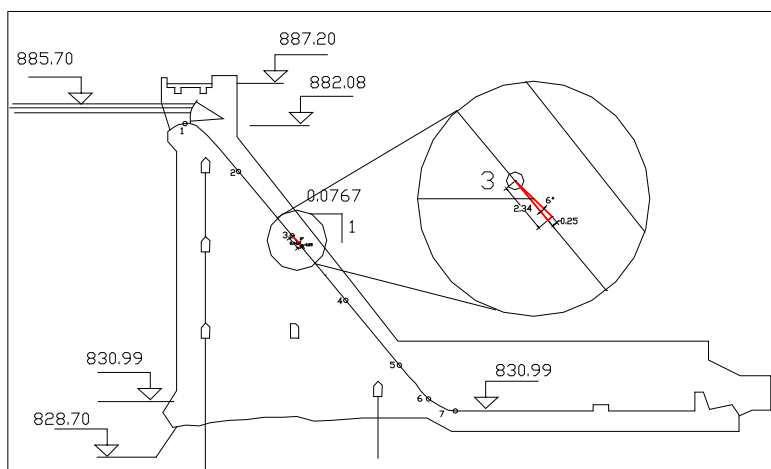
Perfil de localización y dimensionamiento del aireador tipo rampa en la presa Santa Teresa.
